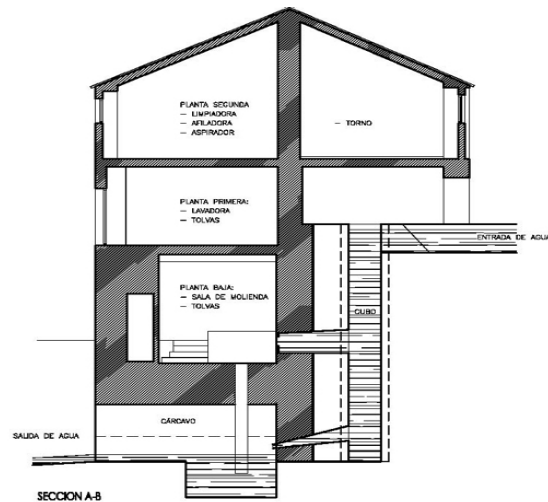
Molino de cubo. Caz en Fachada posterior y Sección constructiva [10]
